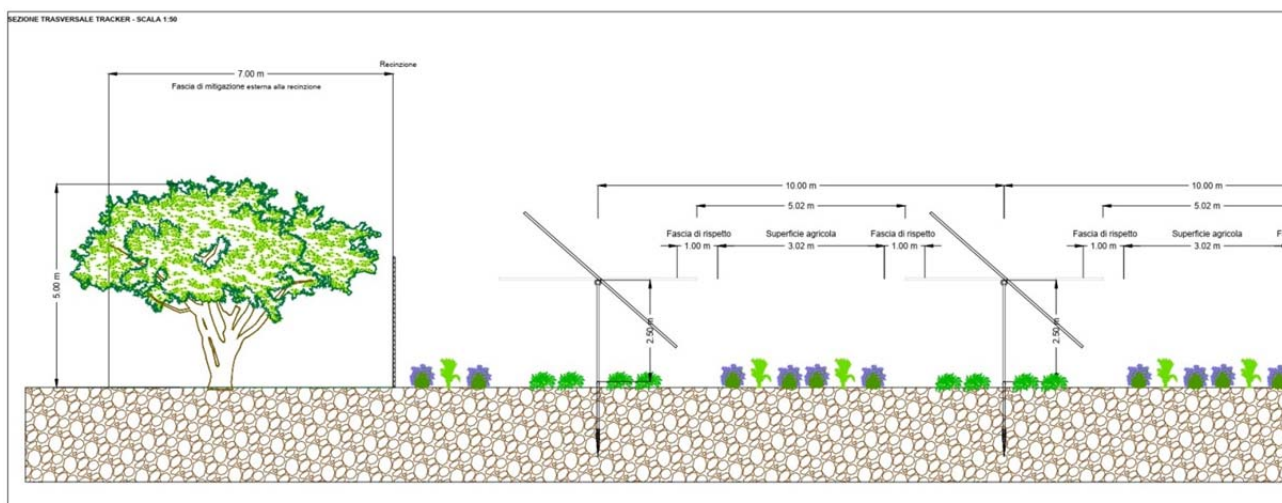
| Particolare sezione trasversale sistema agrivoltaico
